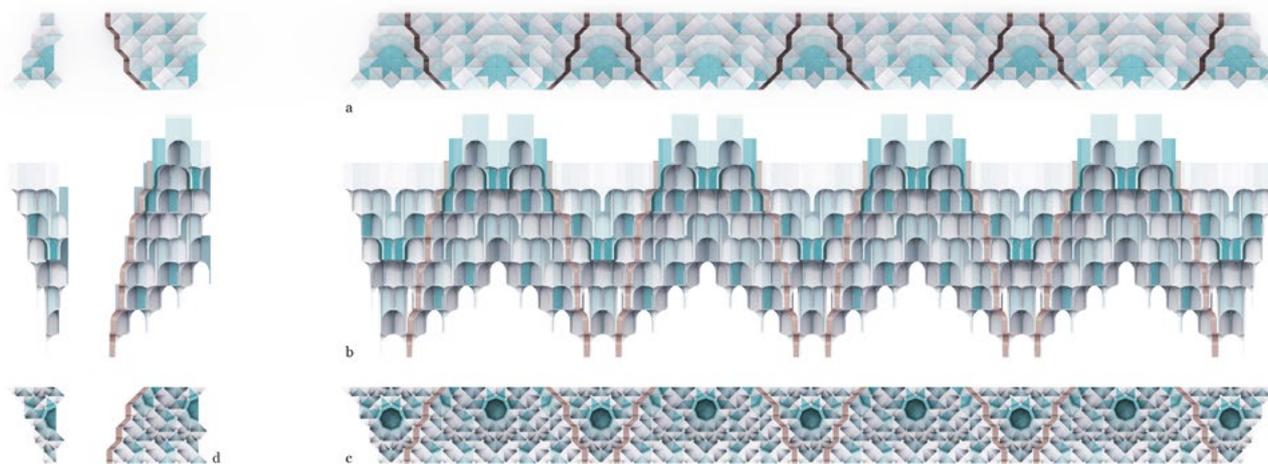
Planta superior (a), alzados (b), planta inferior (c) y módulos de repetición (d) de los mocárabes del friso alto.
